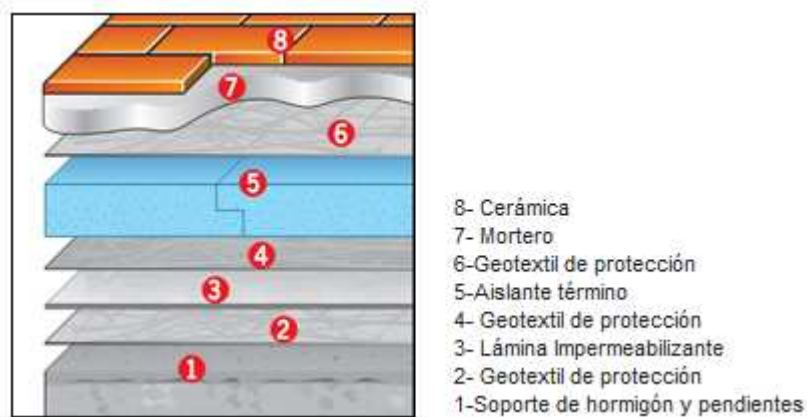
Capas de cubierta plana invertida transitable (terraza).
